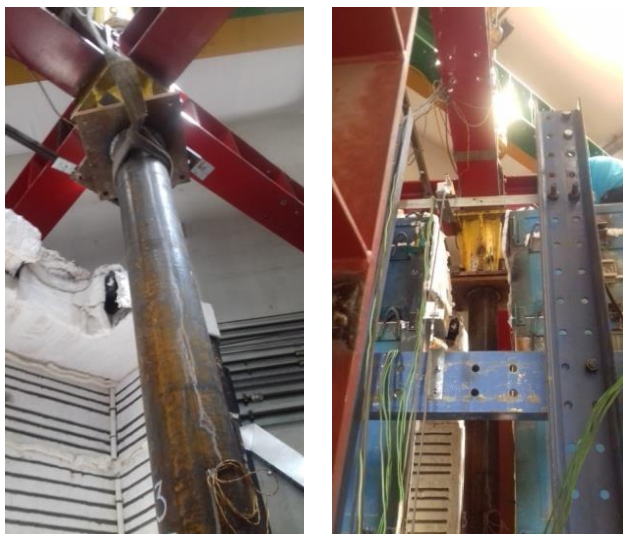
Pilares sendo posicionados para o ensaio.
